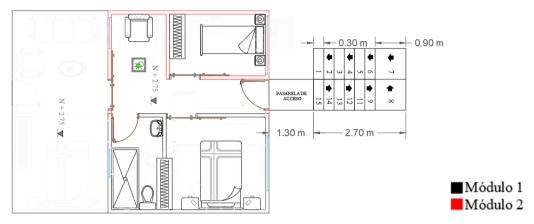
Vista en planta de la vivienda mínima modular ampliada.
